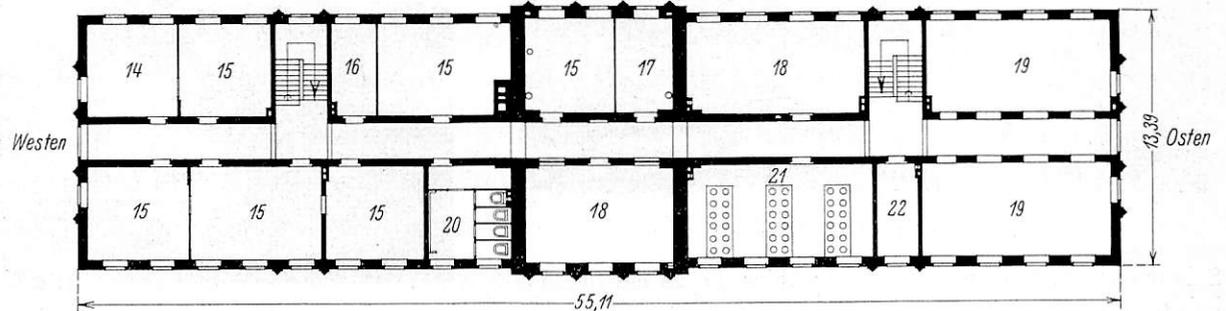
Verwaltungsgebäude. Grundrisse.
